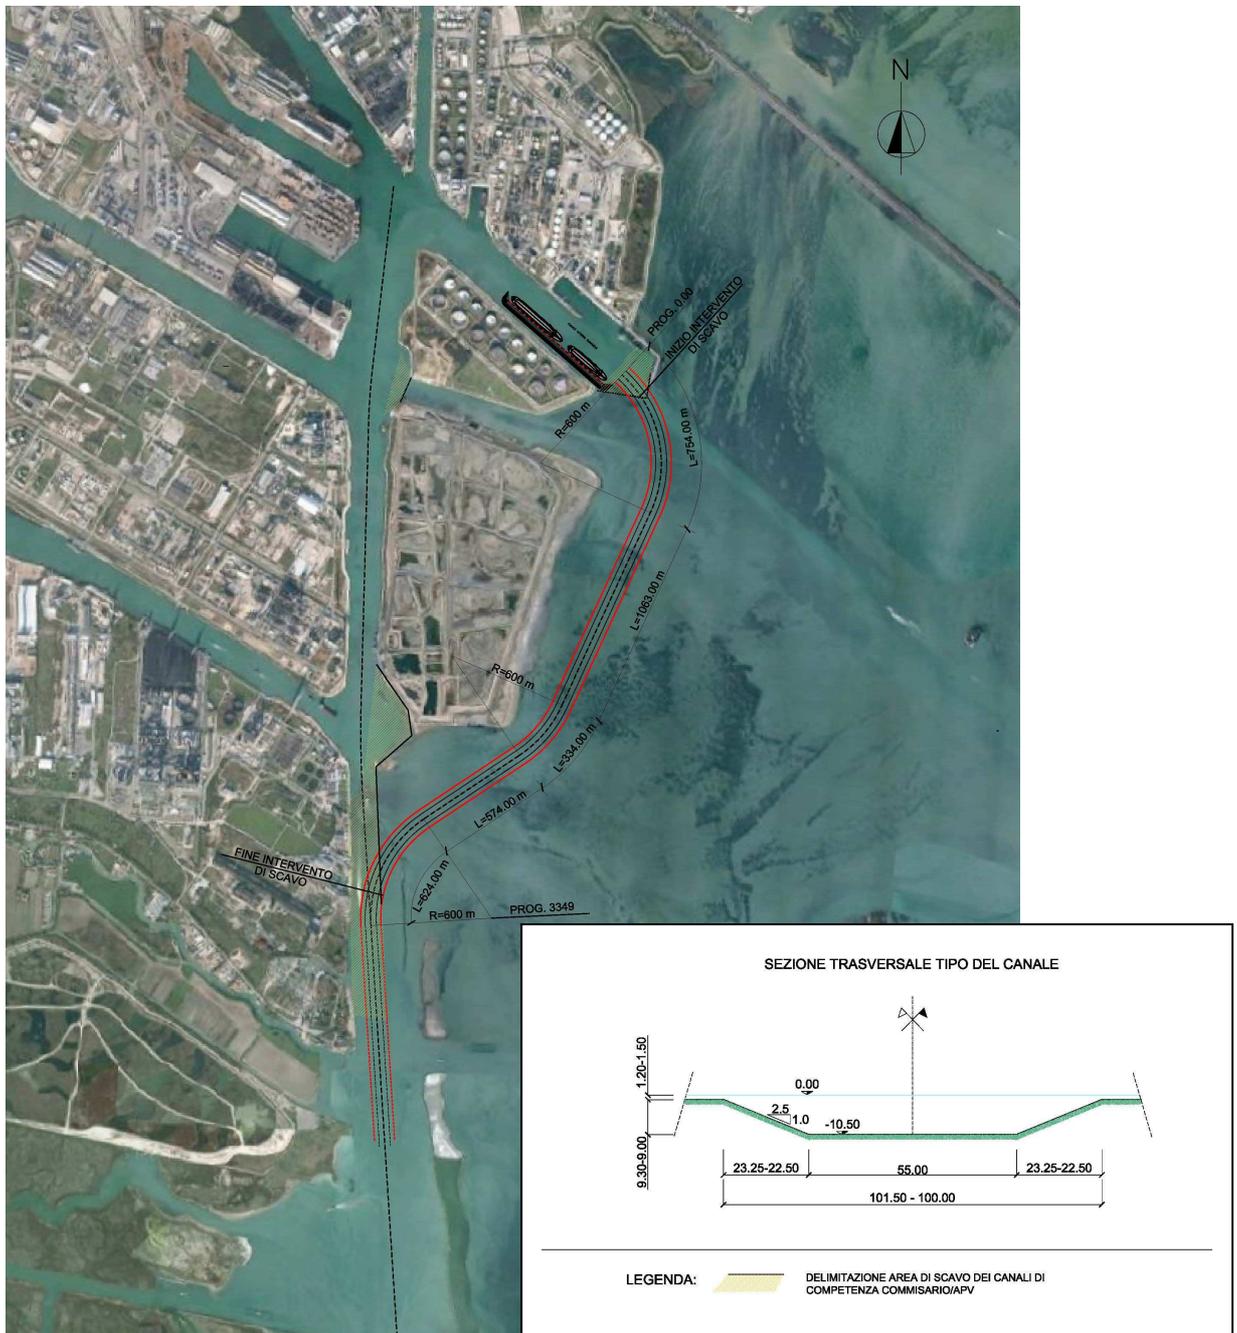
PLANIMETRIA DEL CANALE BY-PASS E SEZIONE TRASVERSALE TIPO
